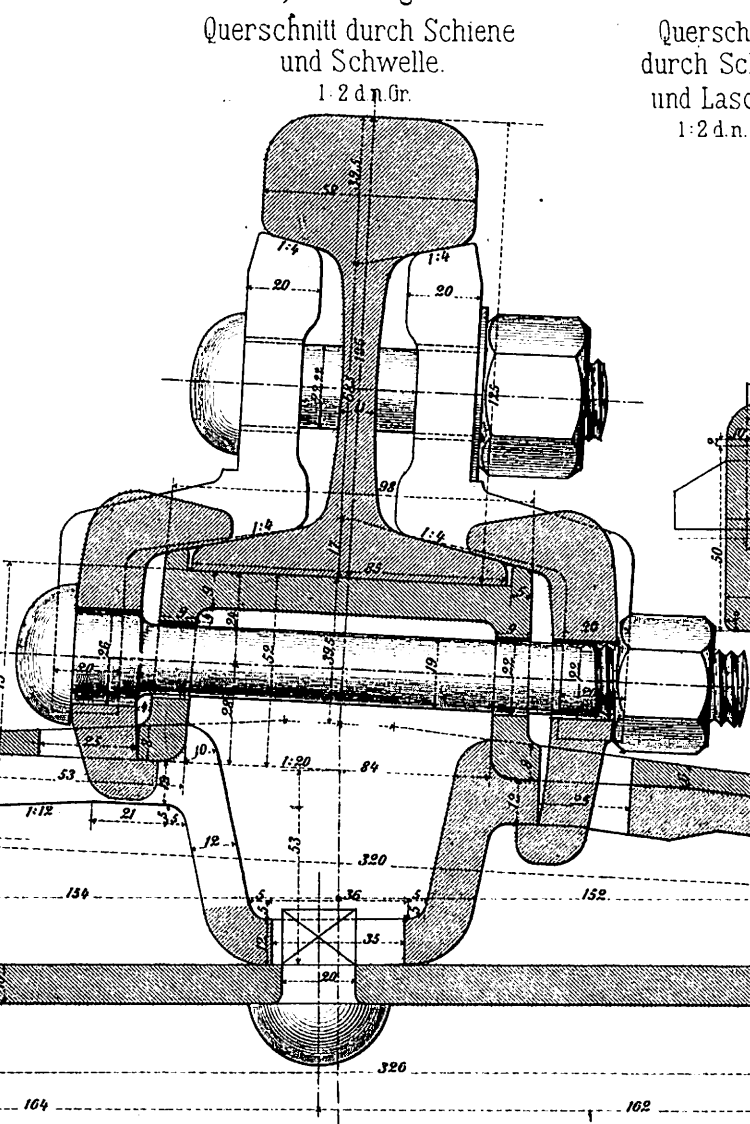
Für Hauptbahnen mit hölzernen Querschwellen.
